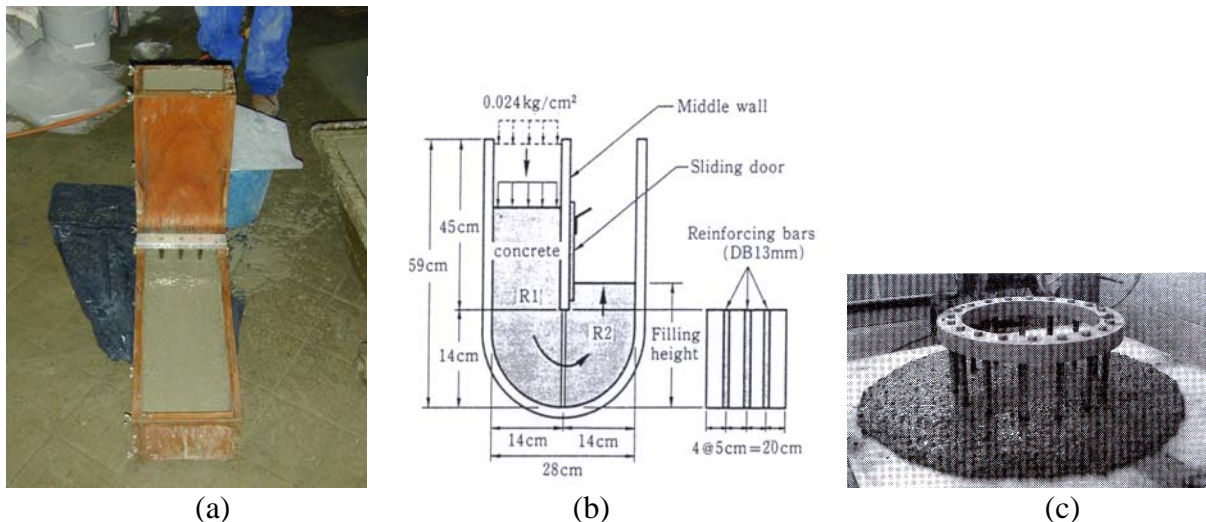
Essais d'écoulement à travers des armatures (a) L-Box, (b) U-box, (c) J-ring
